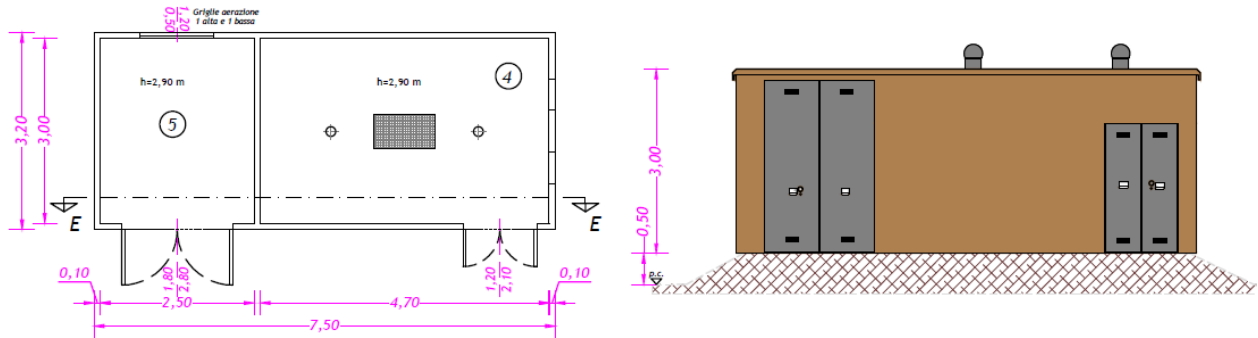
Pianta e profilo delle cabine MT/BT “2.B” e “2.C”
